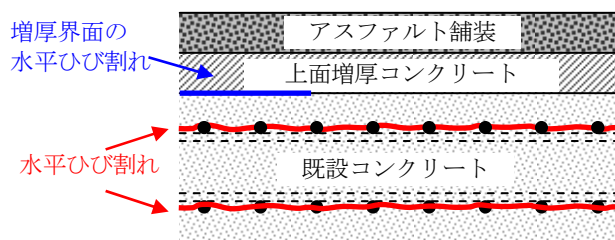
道路橋 RC 床版の水平ひび割れ発生位置
